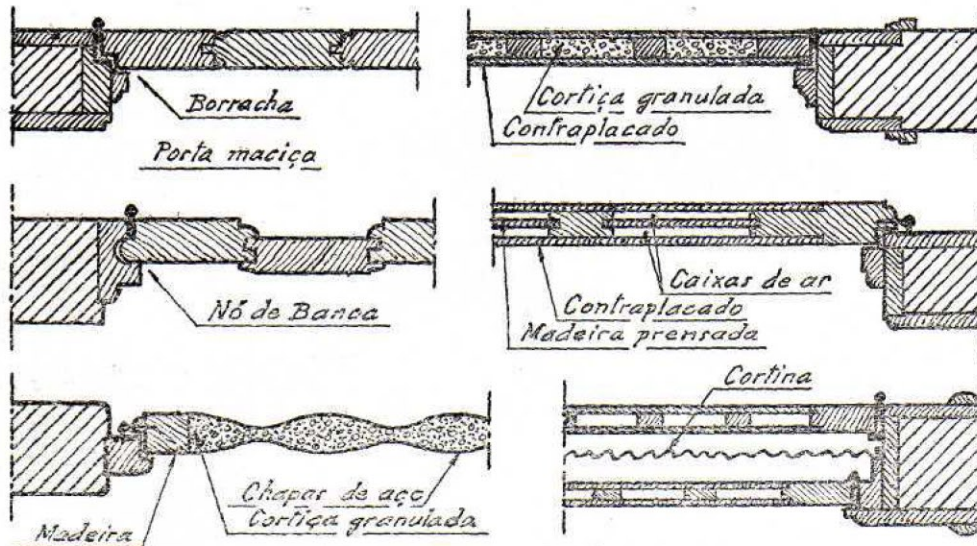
CONSTRUÇÃO DE PORTAS PROTEGIDAS (Cortes horizontais)
